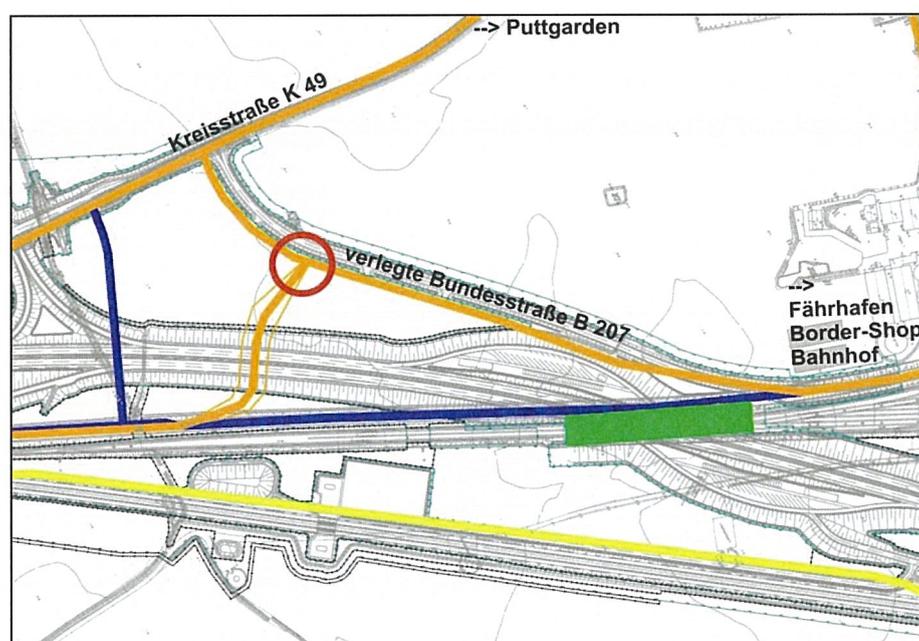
Bau Umleitung B 207 – Anschluss an Hafen
